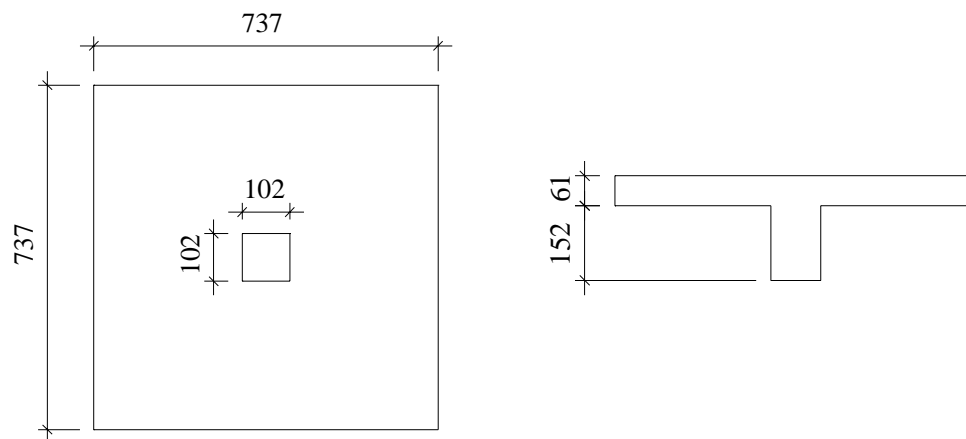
Dimensões das lajes ensaiadas por ROLL at al. (1971) (mm)
